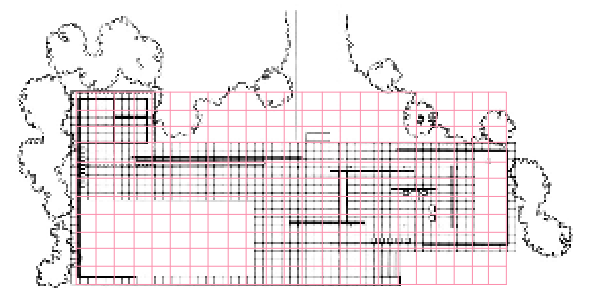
Planta Pavilhão, 1929 (malha quadriculada: desenho do autor).
